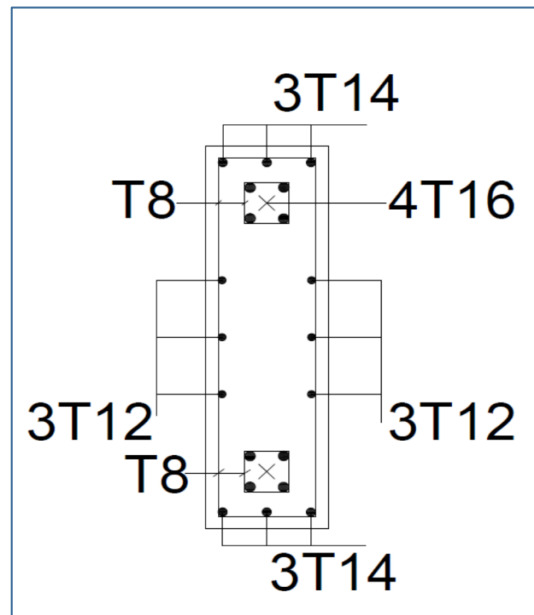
Coupe transversale de ferrailage des linteaux épaisseur 20 et 25.
